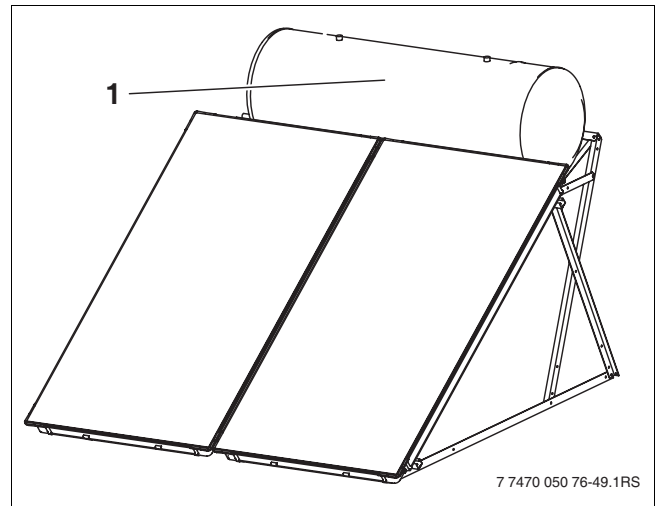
Vista da instalação em telhados planos (aqui, sistema de 300 l)
